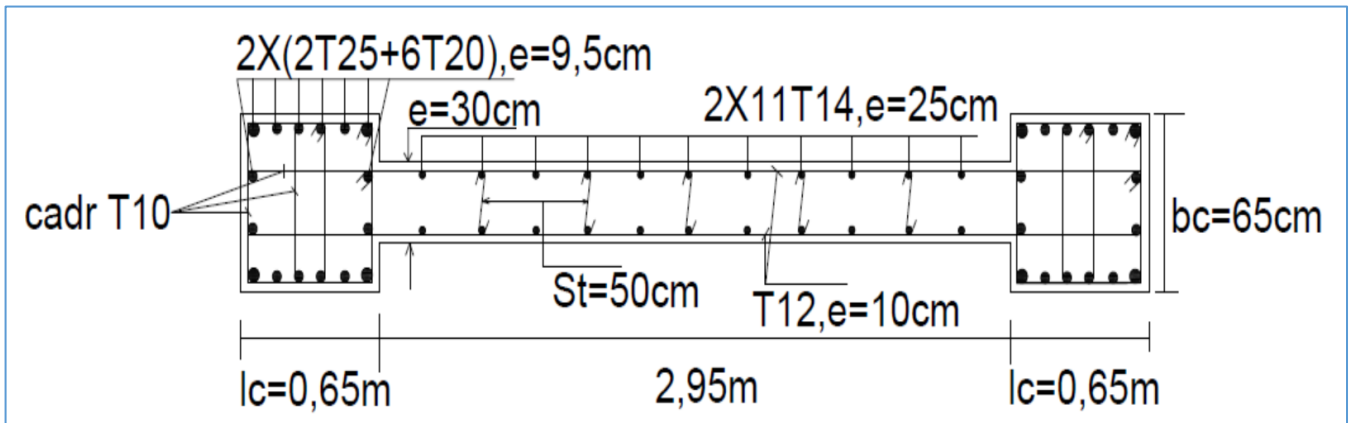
La coupe de ferrailage des voiles sens x épaisseur 30cm.
